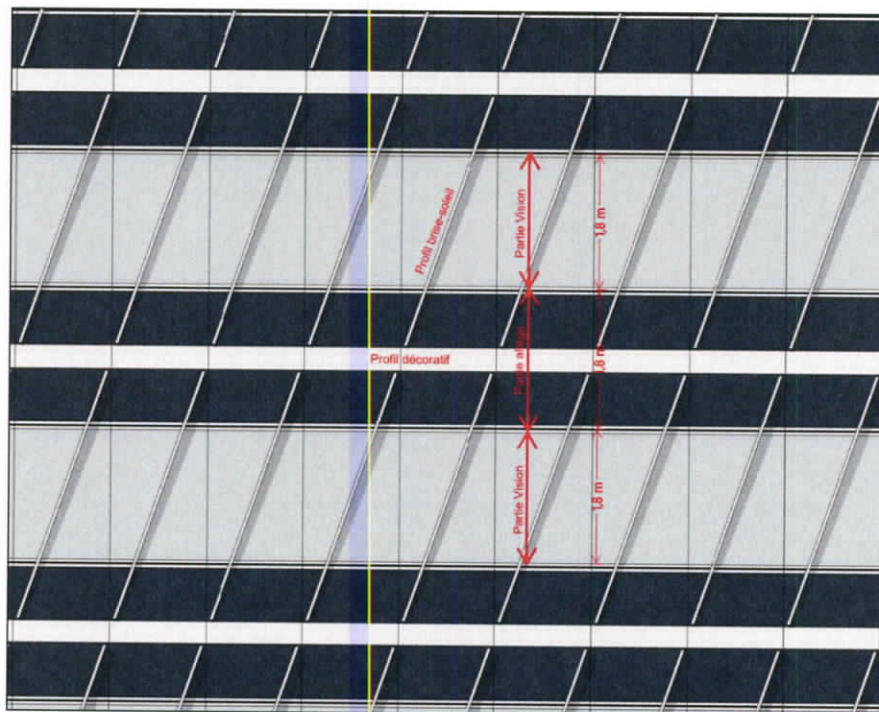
Traitement des façades équipées de brise-soleil inclinés
